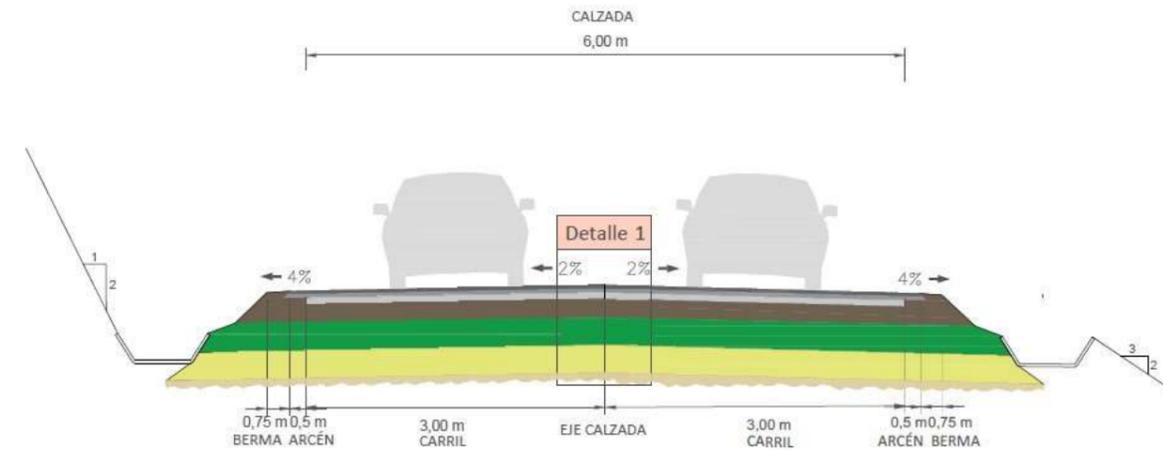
Sección transversal diseñada. (Fuente: Elaboración propia).
